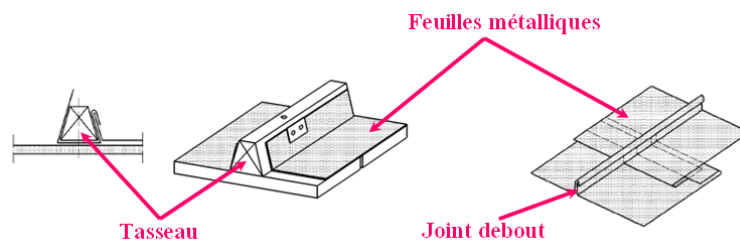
Toitures métalliques à tasseaux et à joints-debout (DTU 40.3)
